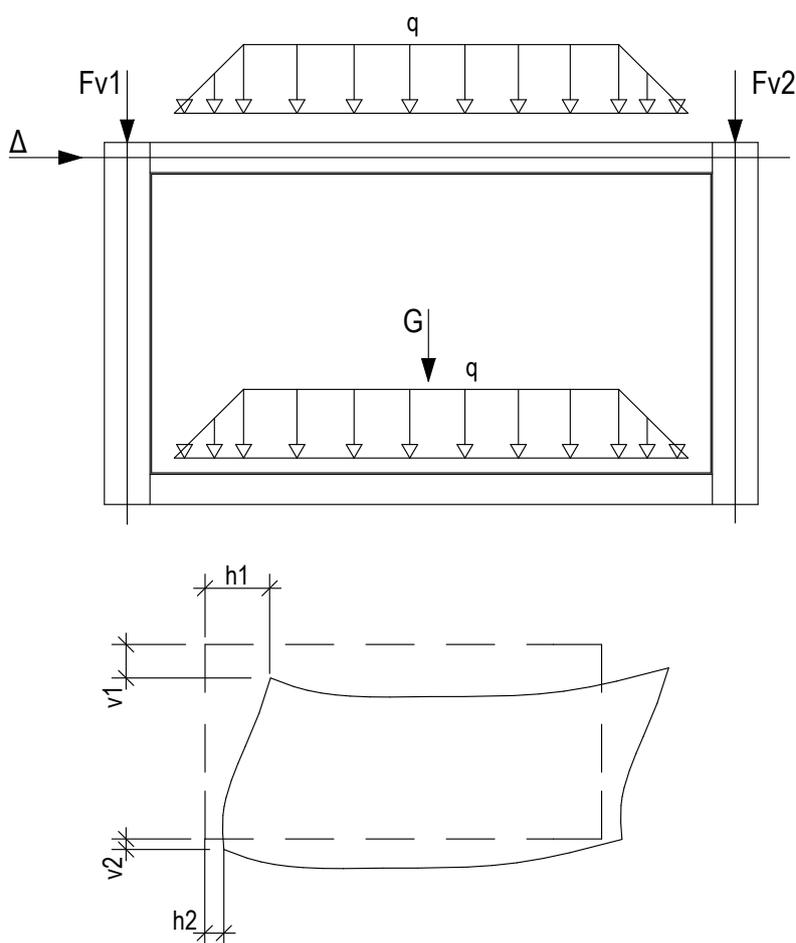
Схемы для определения нагрузок на поэтажно опертые стены
